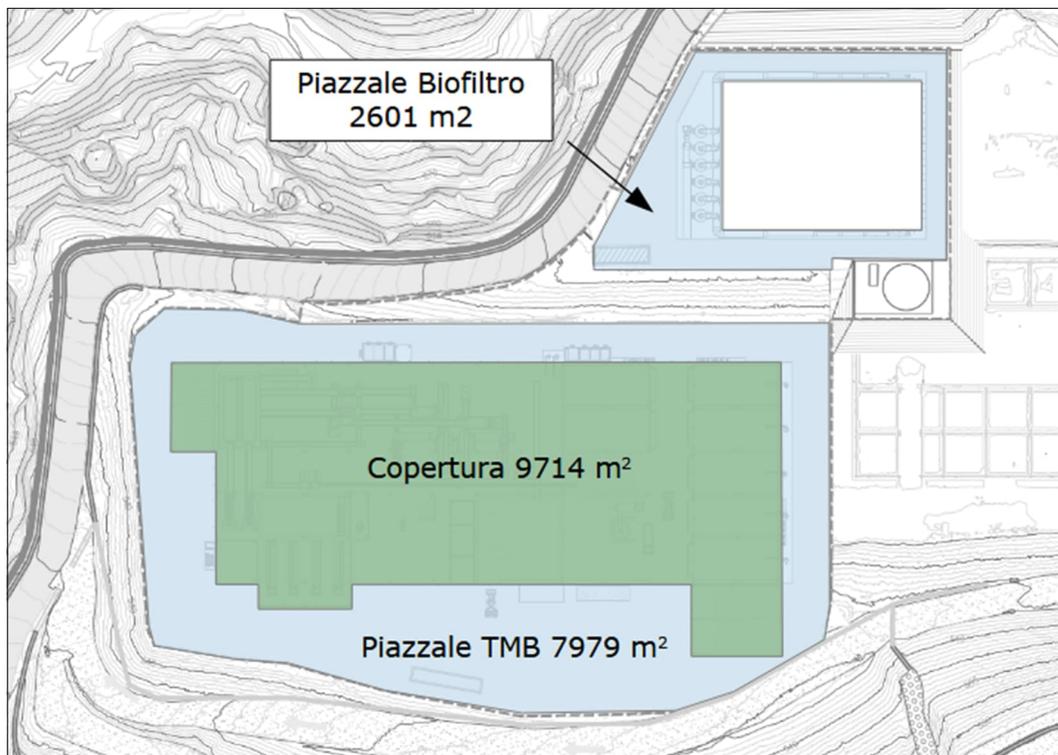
Schematizzazione delle superfici servite dalle reti di raccolta delle acque meteoriche in progetto - - Coperture e piazzali
